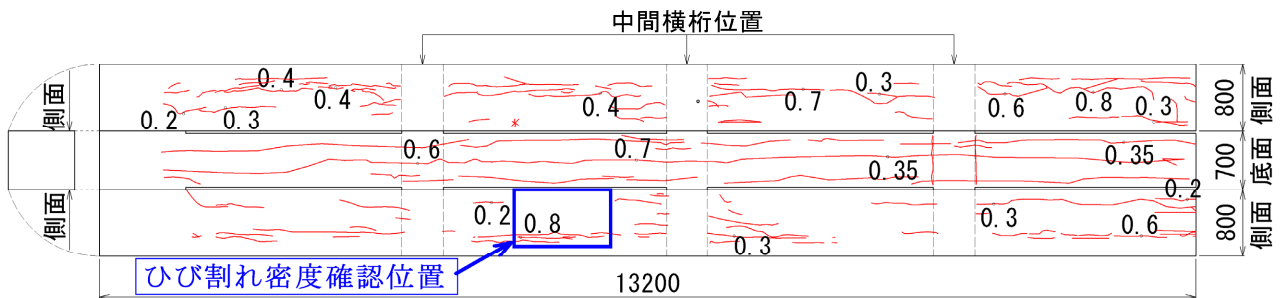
劣化試験桁 G47 のひび割れ状況展開図 (単位 : mm)
